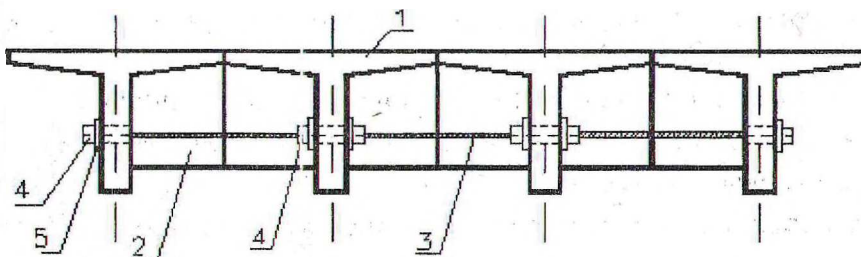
Поперечное обжатие напрягаемым арматурным элементом винтового профиля, закрепляемым после натяжения на стенках крайних и промежуточных балок: 1 – балка; 2 – полудиафрагма; 3 – арматурный стержень винтового профиля; 4 – фиксирующее устройство; 5 – упорная шайба
